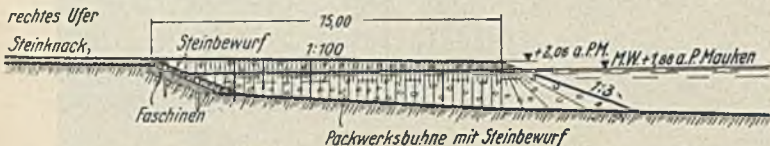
Vorübergehende Sicherung des vorgestreckten Ufers (s. Schnitt A—B Abb. 9).
